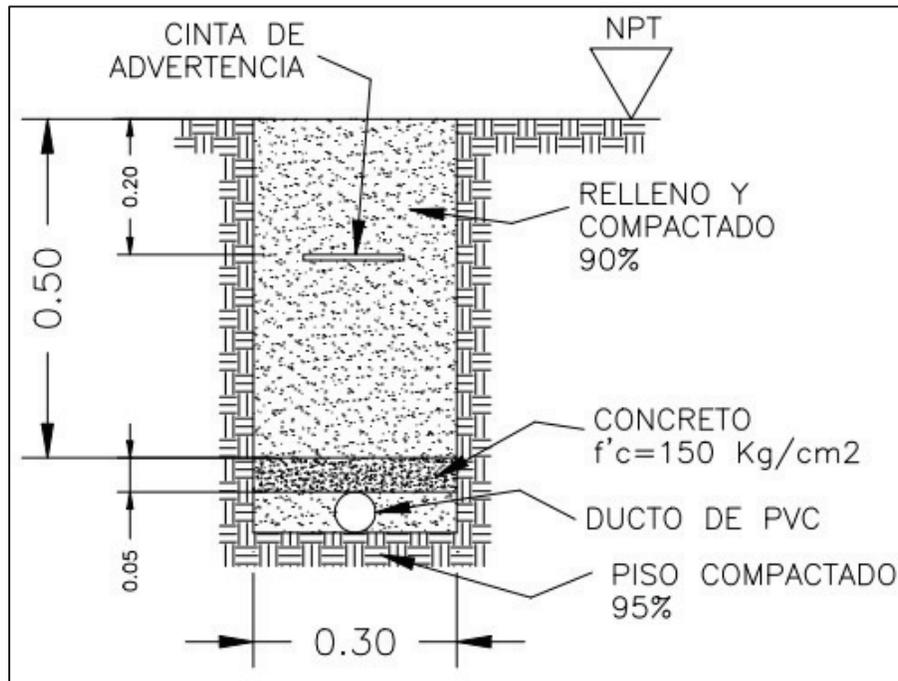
Detalle Ceba en Arroyo con Ducto de PVC.
